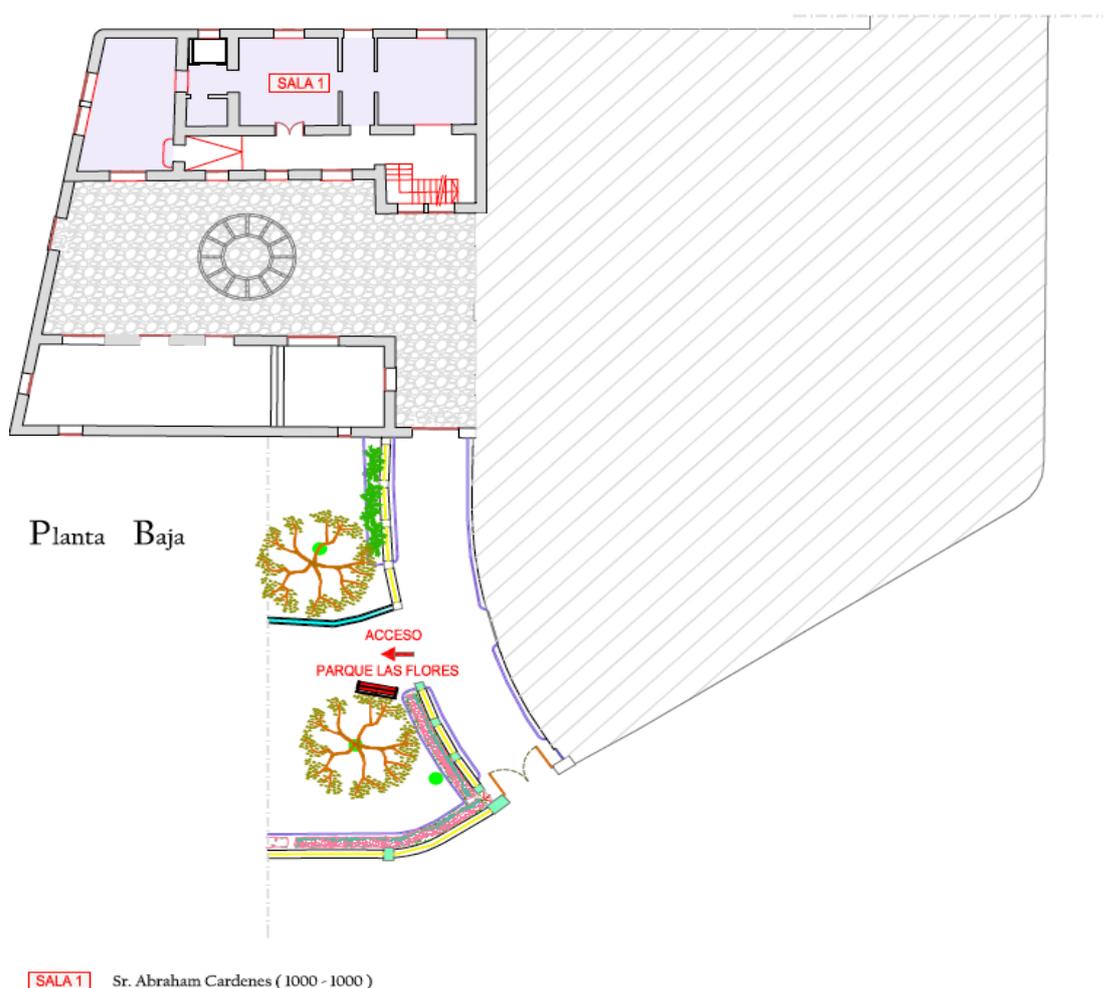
Plano del Museo Municipal. Planta Baja.
